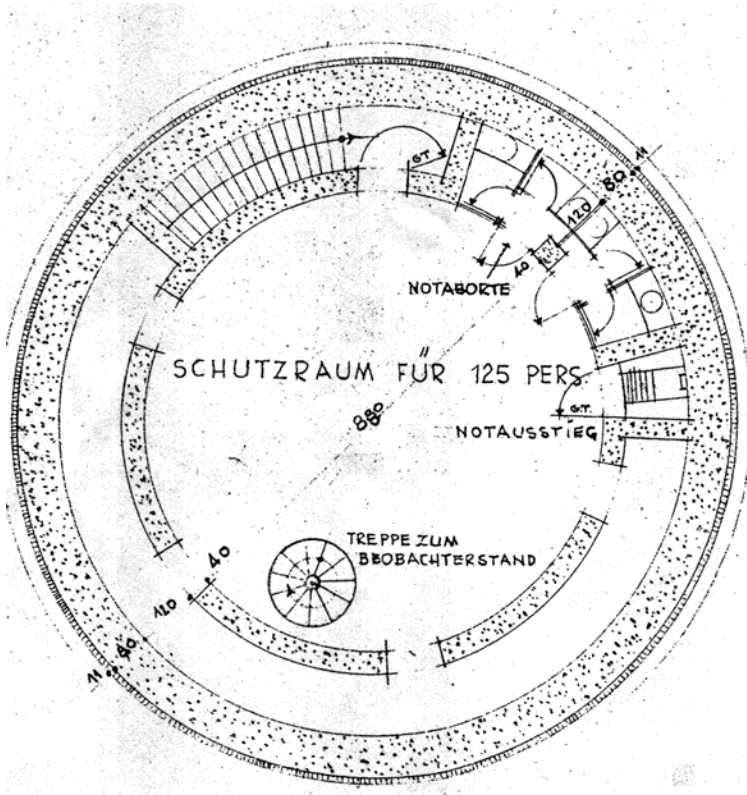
3. Stock (Plan Denkmalschutzamt)
